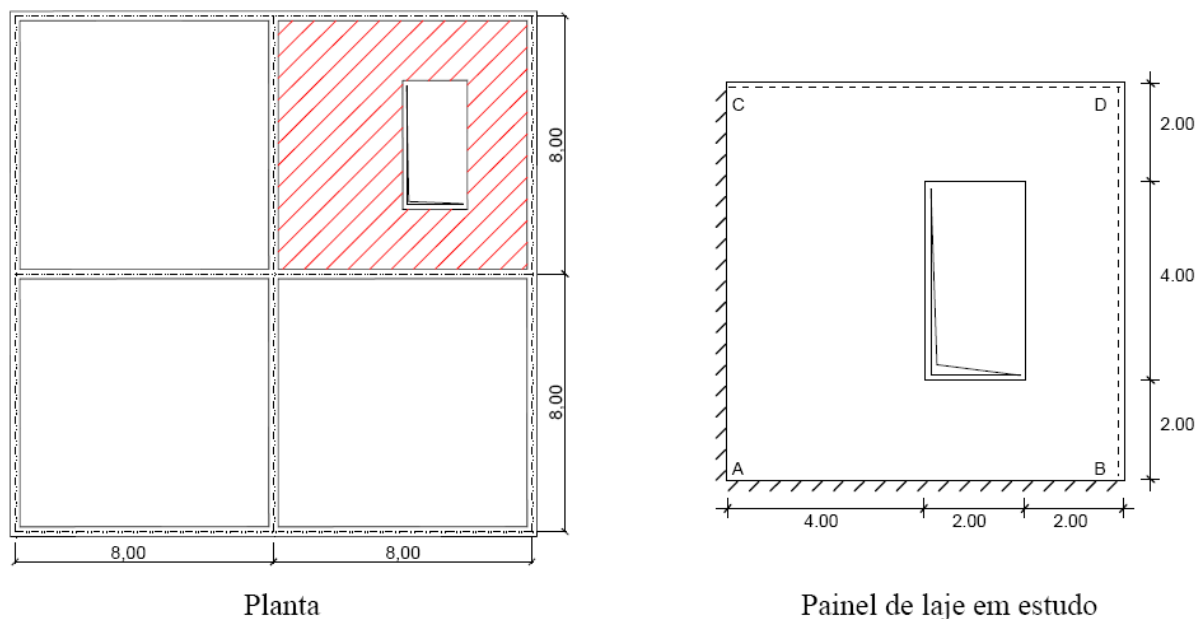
Caso de estudo de uma laje de um pavimento de um edifício industrial
